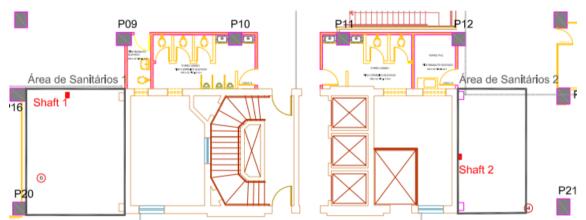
Primeiro Pavimento – Localização da área dos sanitários existentes diferentes da área dos sanitários existentes nos 3º e 2º pavimento
